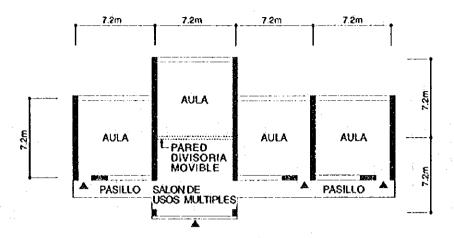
PLANTA DEL EDIFICIO DE AULAS TIPO 4-4-8
